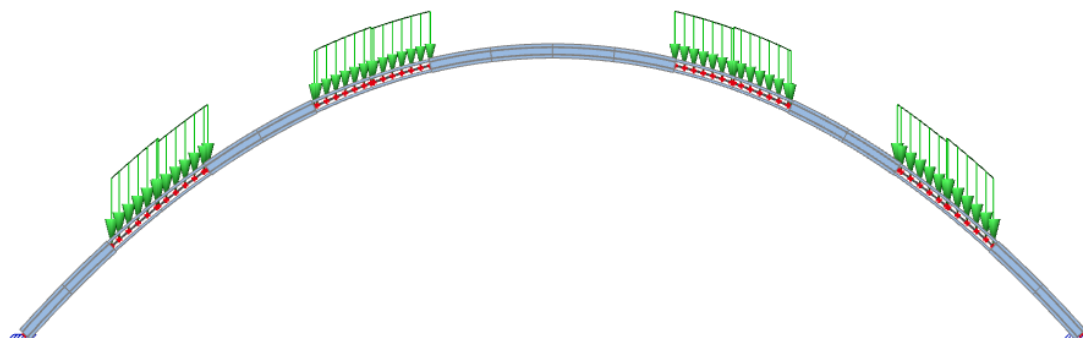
Zatížení oblouku čerstvým betonem v první etapě jeho betonáže
